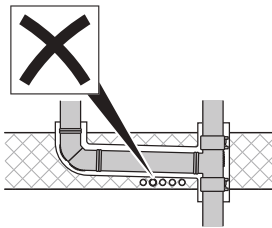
Ingen korsning med betongingjutna vattenledningar eller elinstallationsrör
